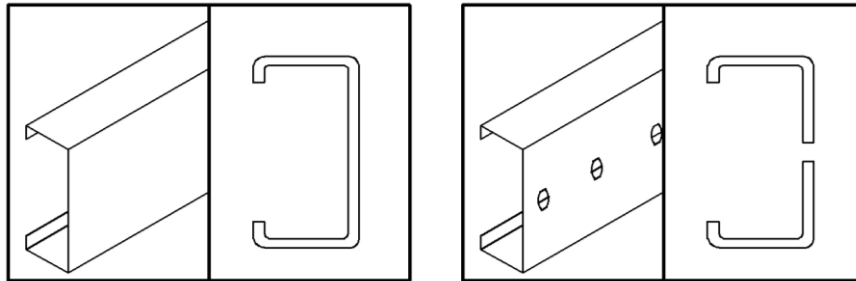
Perfil estructural tipo "C" y con perforación.
